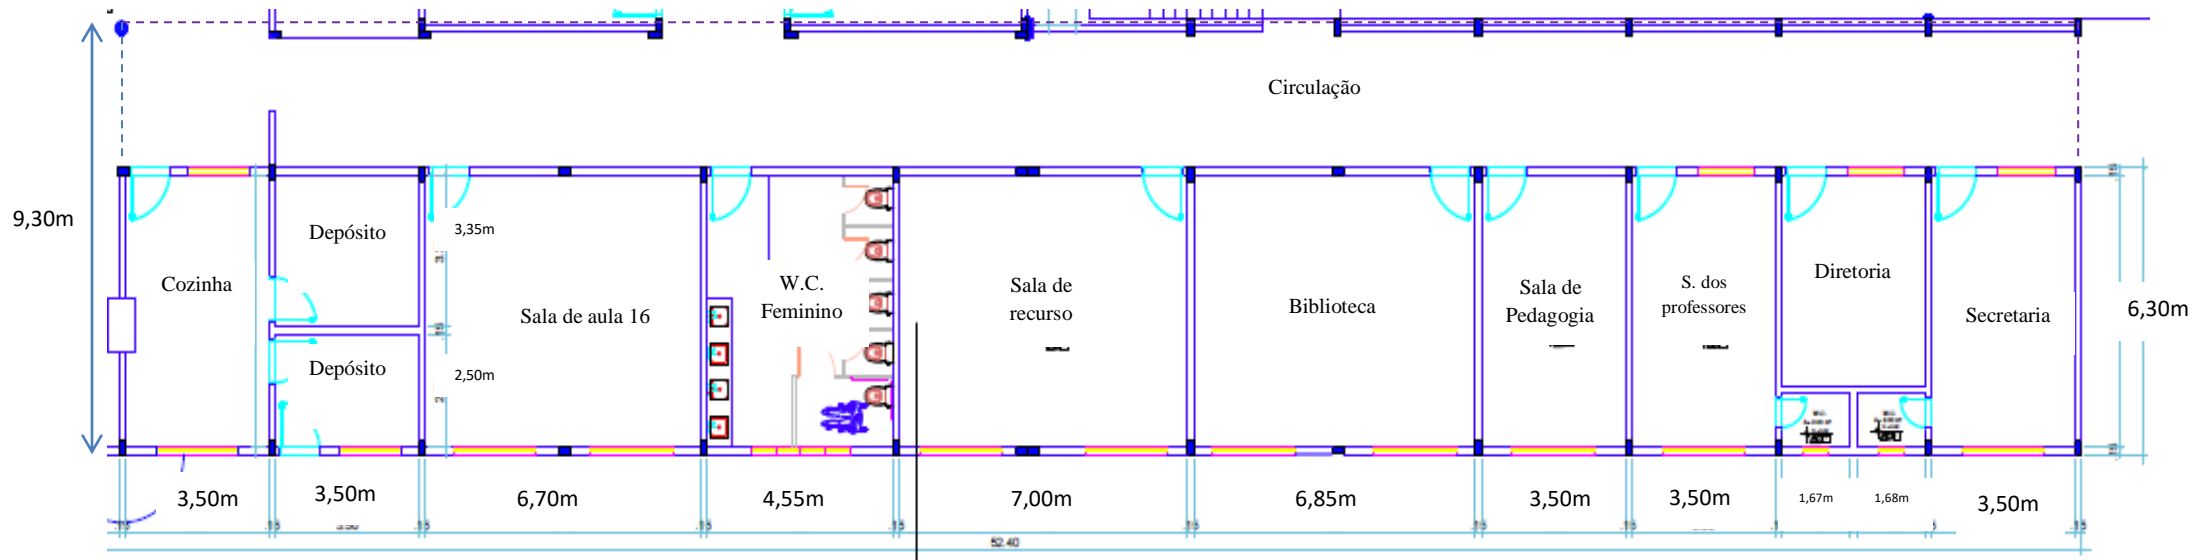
Planta baixa 2º pavimento do 1º Centro Municipal de Educação em Educação Walter Cabral
